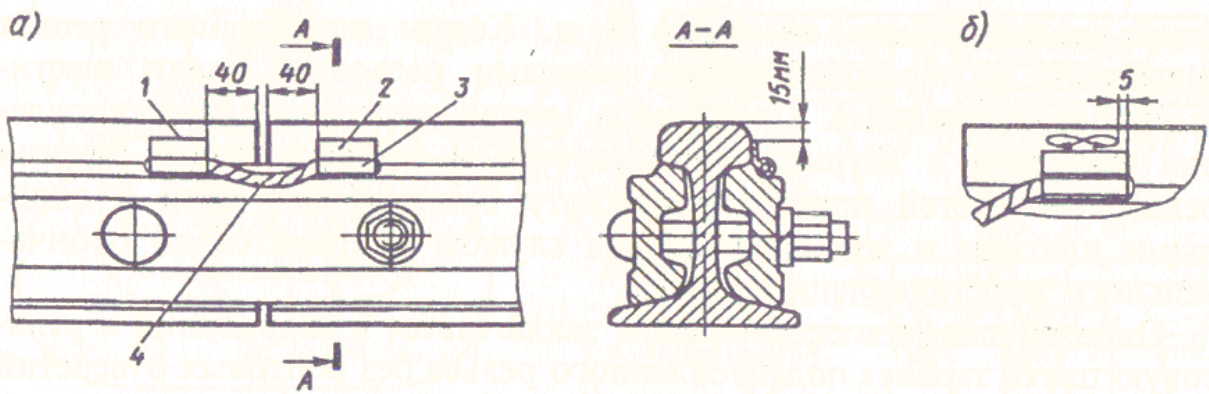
Схема установки (а) и приварки (б) медного соединителя фартучного типа к головке рельса (мм):
